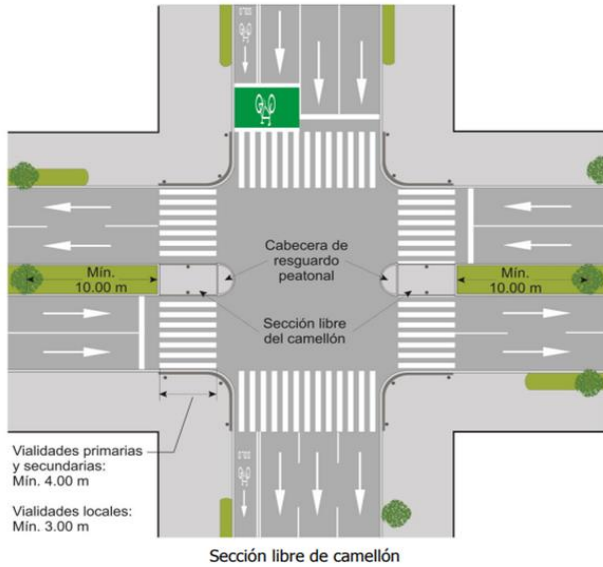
Sección libre de camellón Fuente: Norma Técnica
